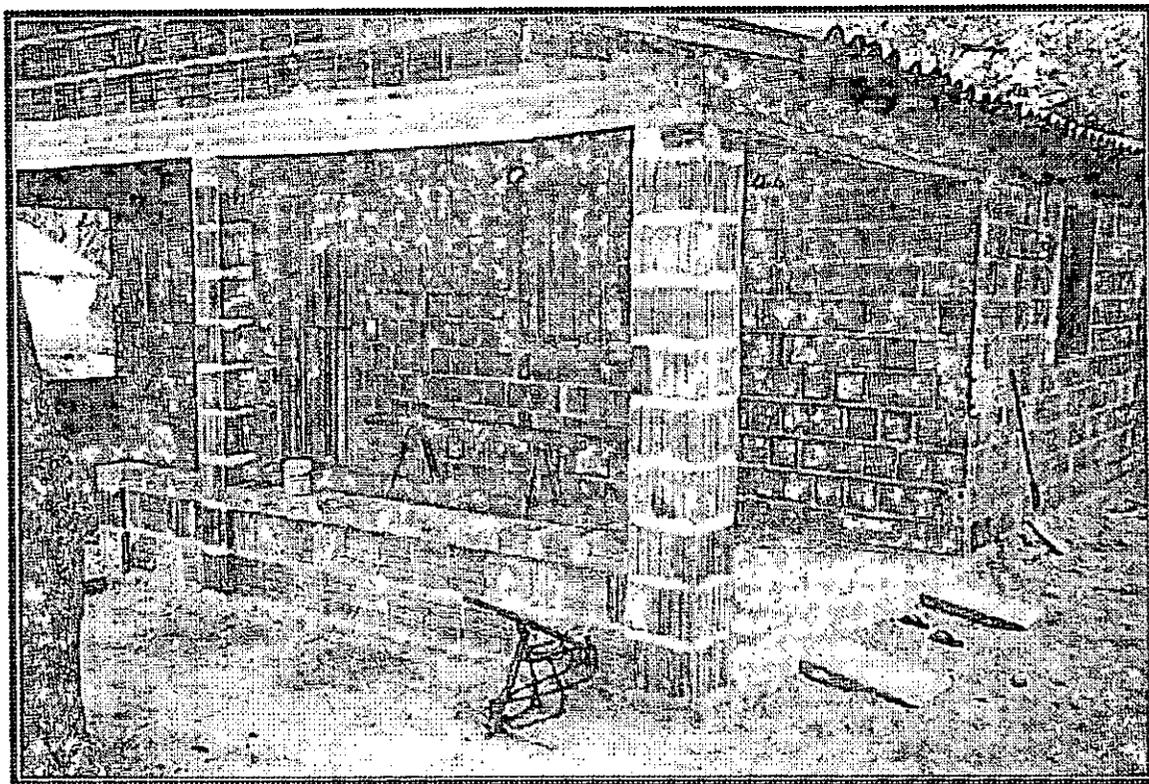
CASA DE PROPRIETÁRIO RESIDENTE, Sr. ELIAS L. DA SILVA
